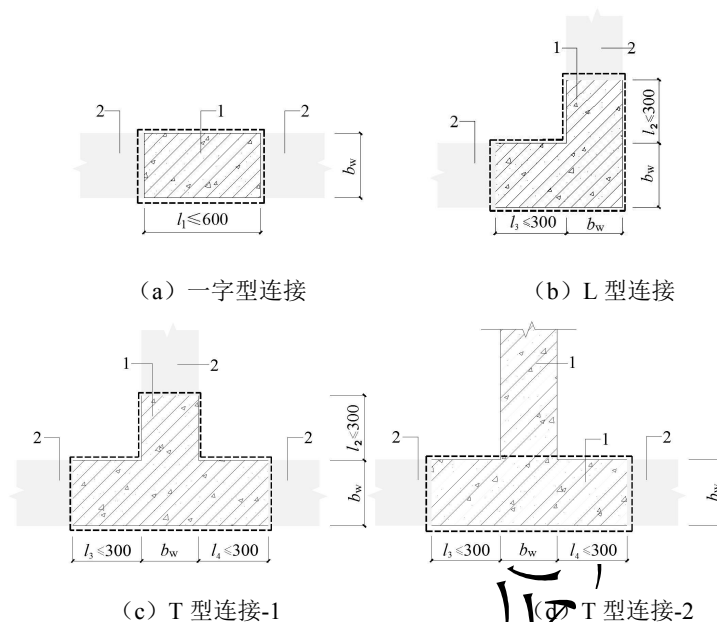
竖向构件间连接部分的后浇混凝土计入预制混凝土体积的允许尺寸示意图
